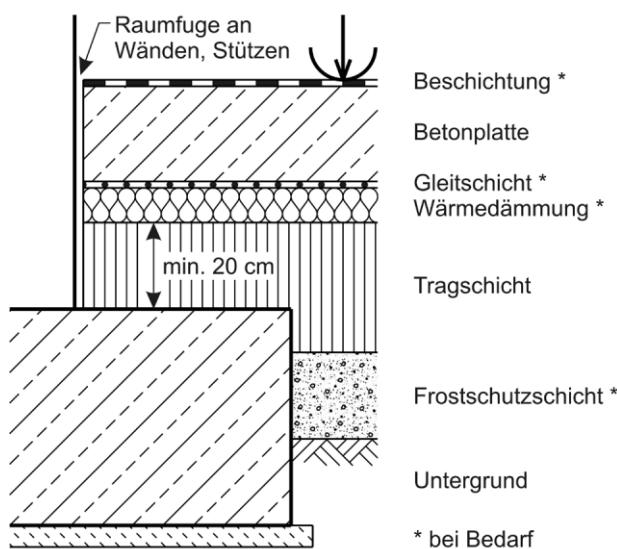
Prinzipieller Aufbau einer Beton-Bodenplatte
